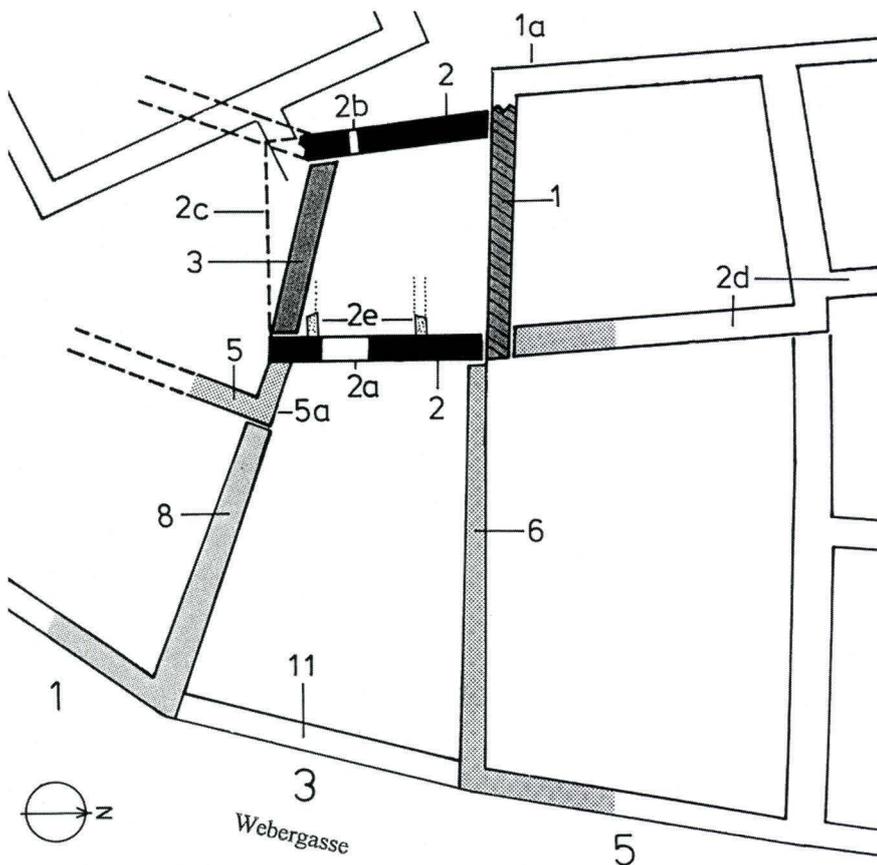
Grundriss von Webergasse 1–5 mit den wichtigsten Bauphasen. – Zeichnung: Rebekka Brandenberger nach Vorlage von Stephan Tramèr.
